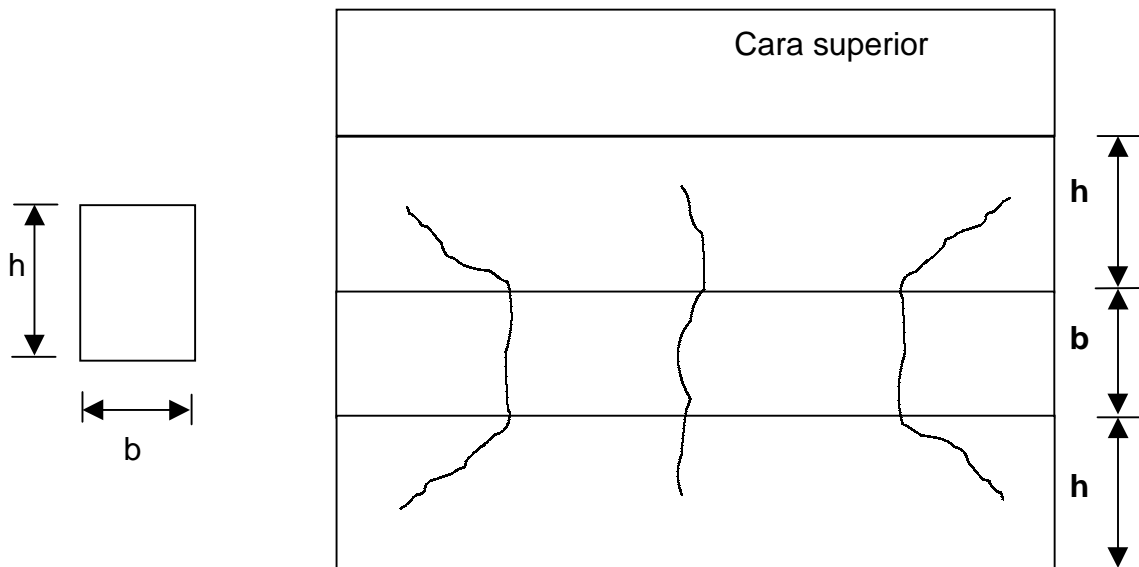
Ilustración del levantamiento de fisuras en una viga.
